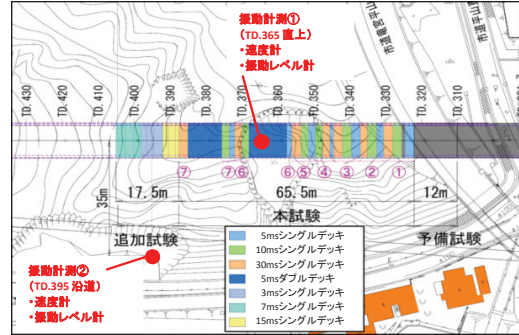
発破試験区間と振動計測位置(平面図) (Plan View of Test Area and Monitoring Point)
